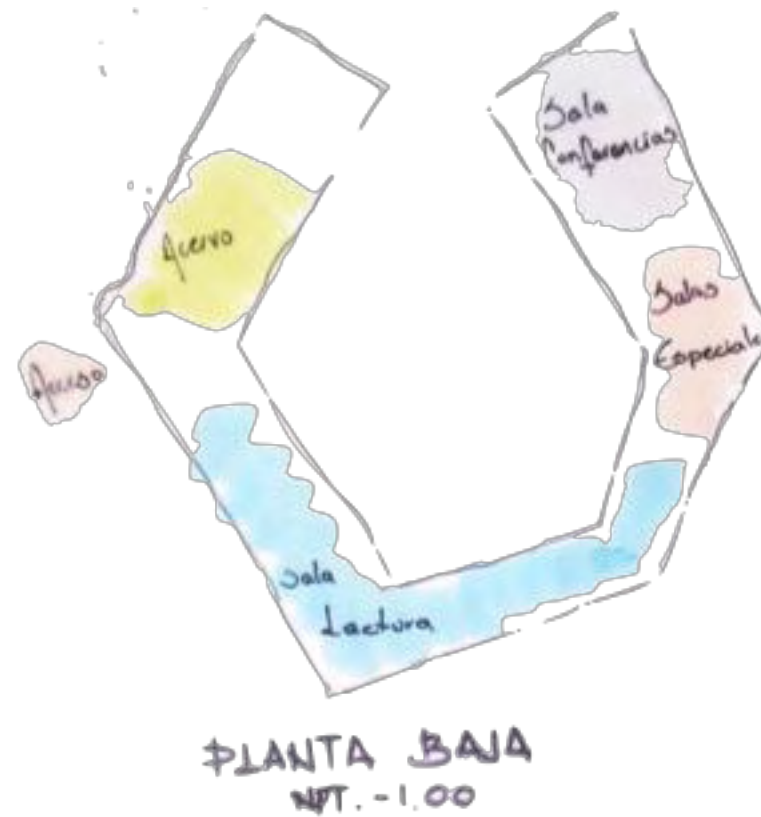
Zonificación biblioteca, planta baja (ACS, 2013)
